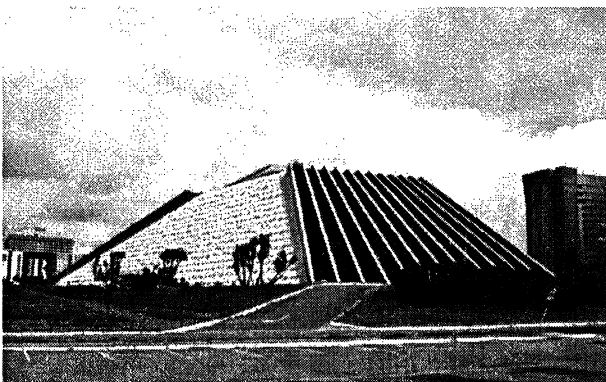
Vista del Teatro Nacional mostrando las vigas-pilares de las fachadas Este y los bloques de hormigón de la fachada Sur.
